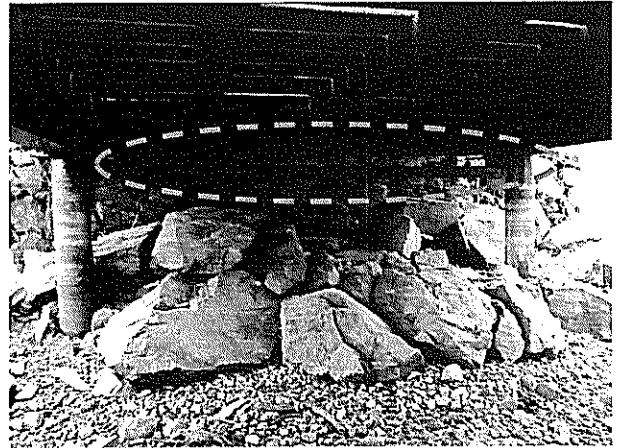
La separación entre soleras es superior al especificado, y emboquillado quebrado.
